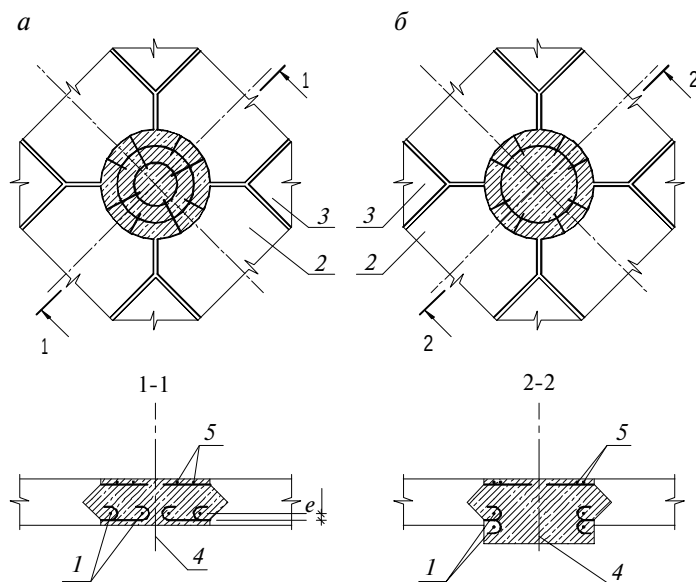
Квадратная ячейка перекрытия стороной до 6 м с контурными и диагональными ригелями. Узел пересечения диагональных ригелей:
